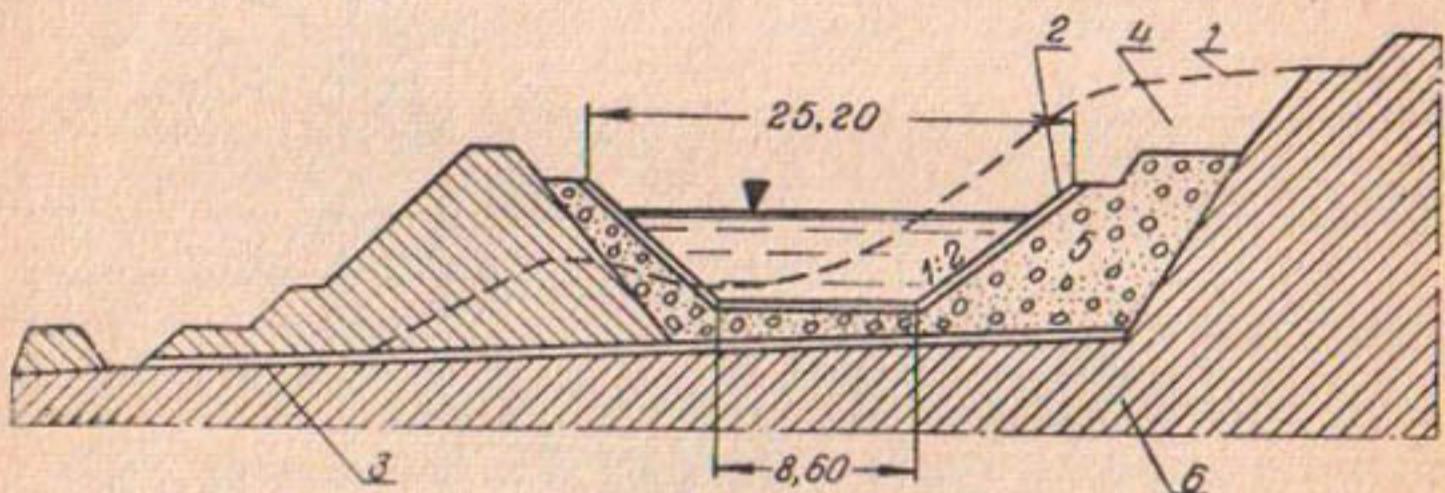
Поперечное сечение канала, на котором была произведена замена неустойчивого грунта фильтрующим:
